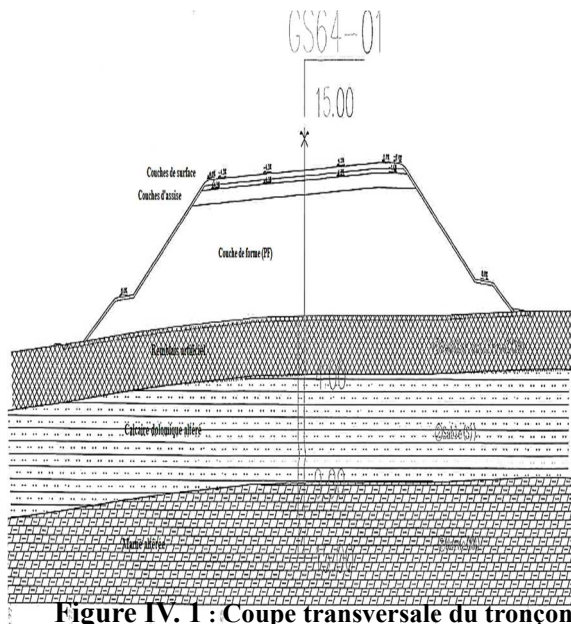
Coupe transversale du tronçon Autoroute
